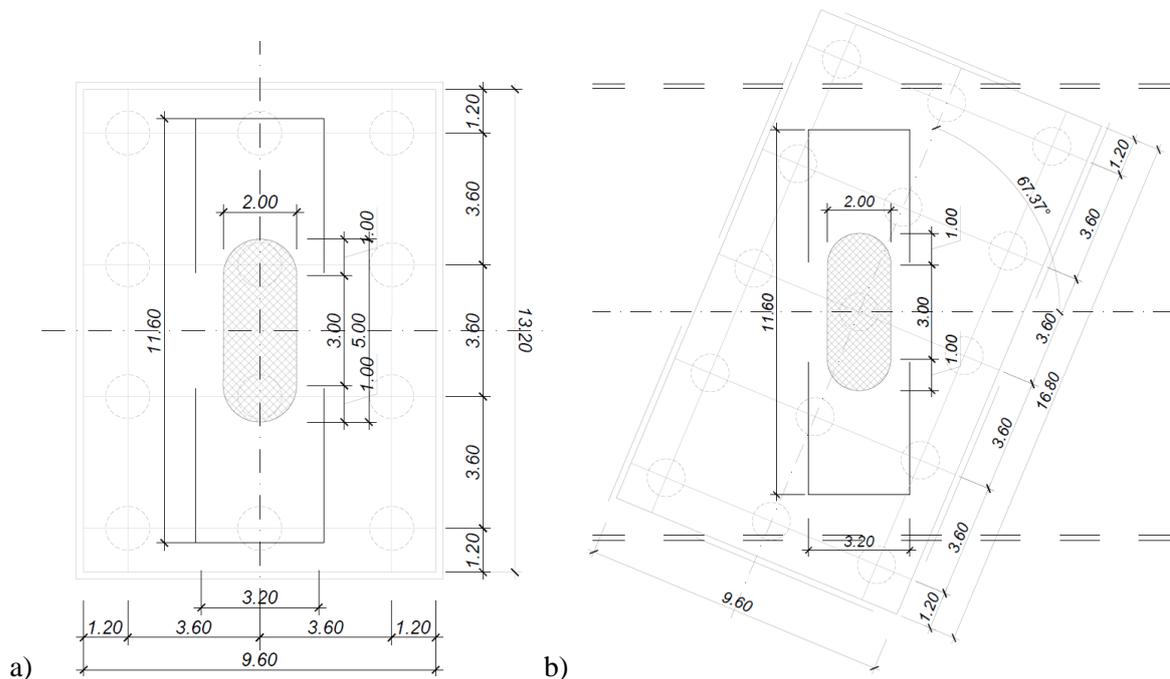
Vista in pianta pila- a) sezione di spiccato pile 1-4 ; b) sezione di spiccato pile 2-3
